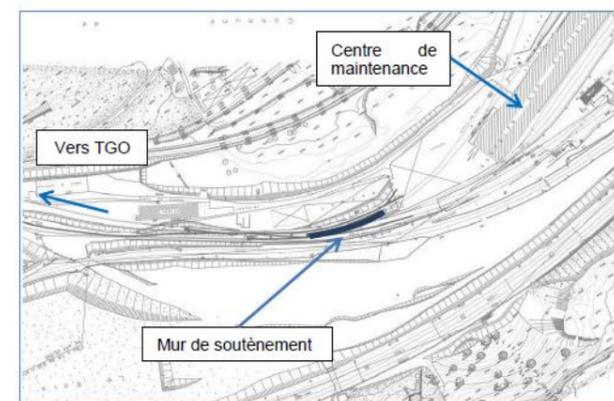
Plan d'implantation du mur de soutènement du SMR (Source : AVP- juillet 2015)
